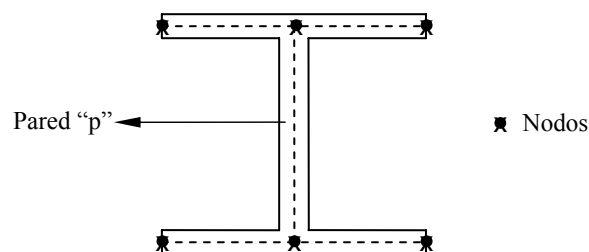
Elementos de la Sección Transversal del Muro Estructural.
